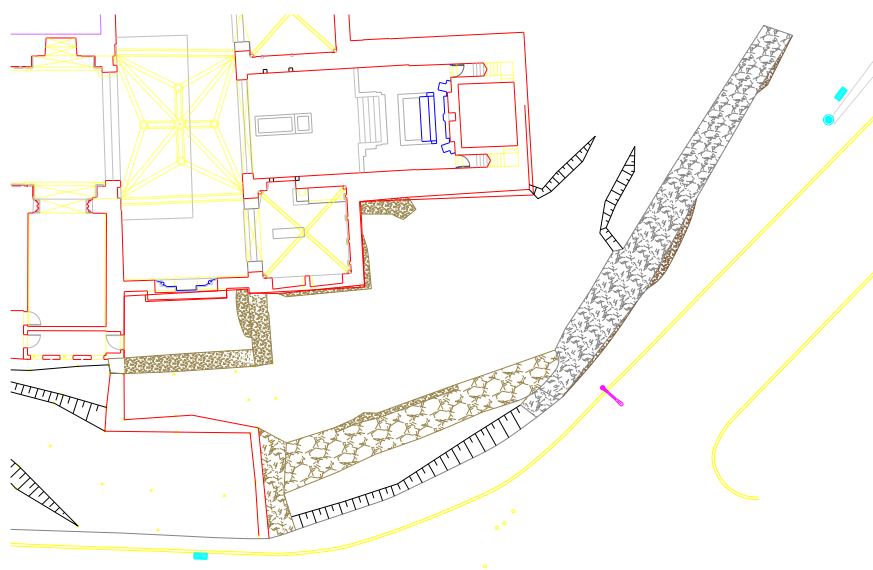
Levantamento topográfico da Cerca e estruturas arquitetónicas
